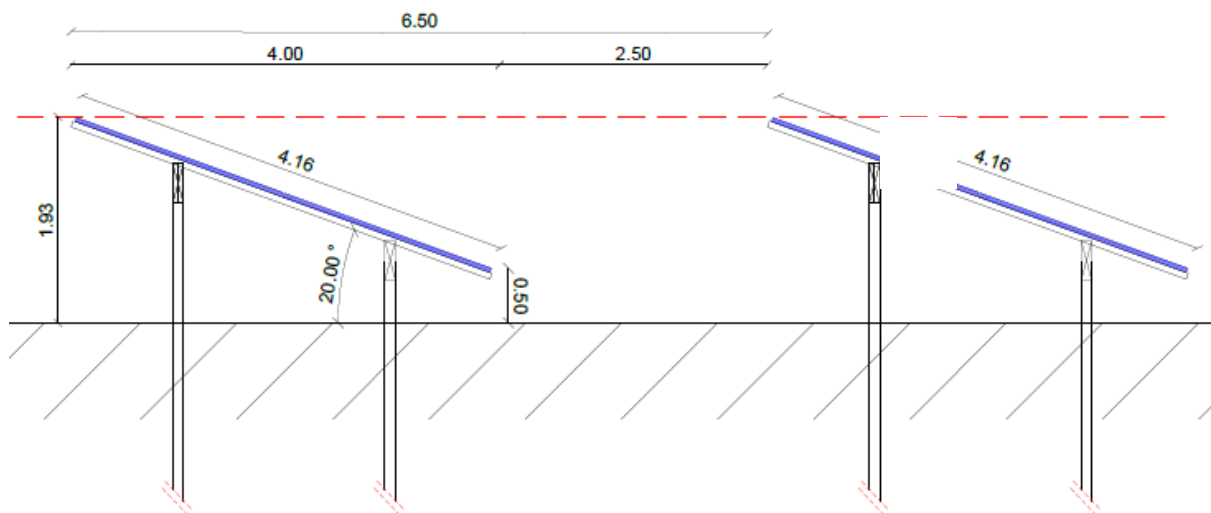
Exemple de plan en coupe pour l’implantation avec des pieux battus
